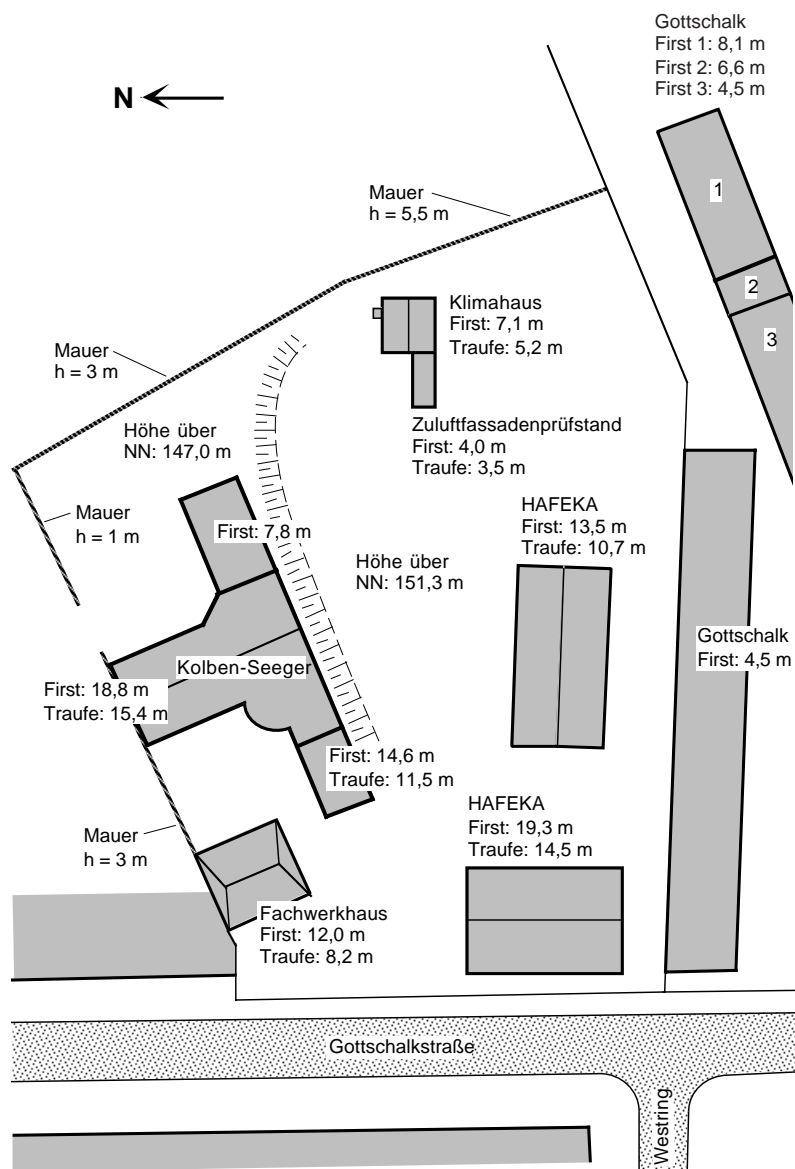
Schematischer Lageplan des Klimahauses mit Angabe der Höhen umliegender Gebäude.
